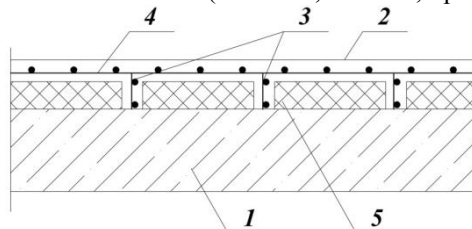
Устройство железобетонного наращивания в виде кессонной плиты [16]:
